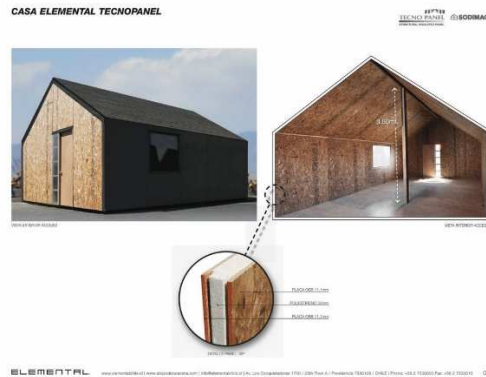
Vista exterior e interior de viviendas elemental tecnopanel
